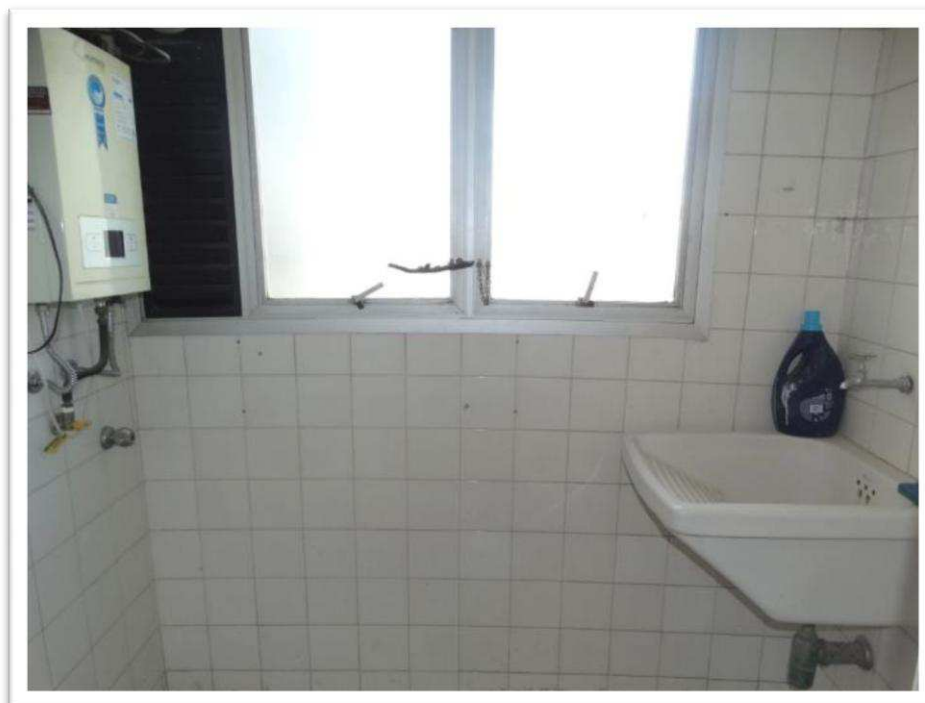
Vista parcial interna do apartamento nº 111 do Edifício Via Colomba – Área de Serviço.
